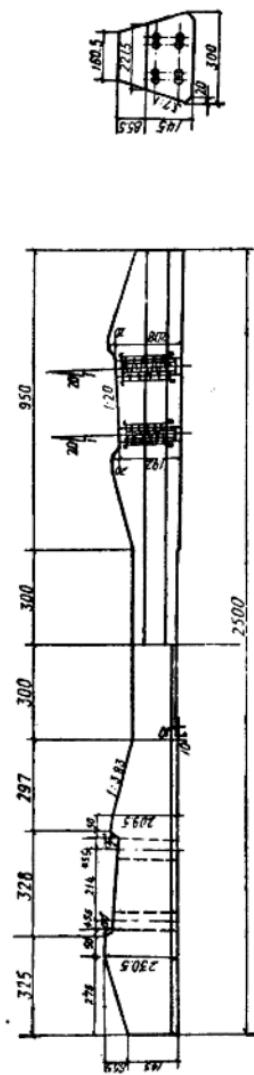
筋I 60 A型预应力粗钢筋混凝土轨枕
